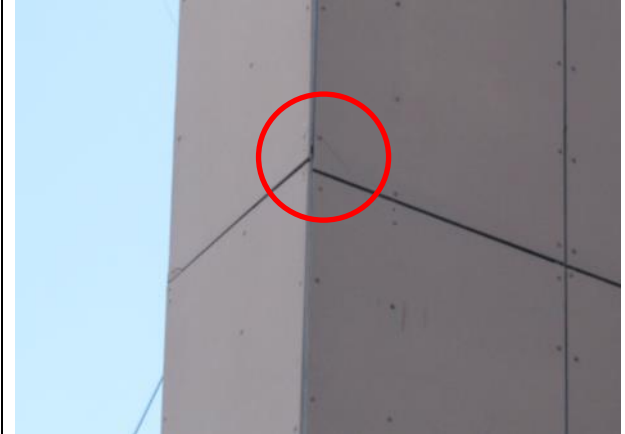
Сколы с выпадением частей плит из облицовки дворового фасада
